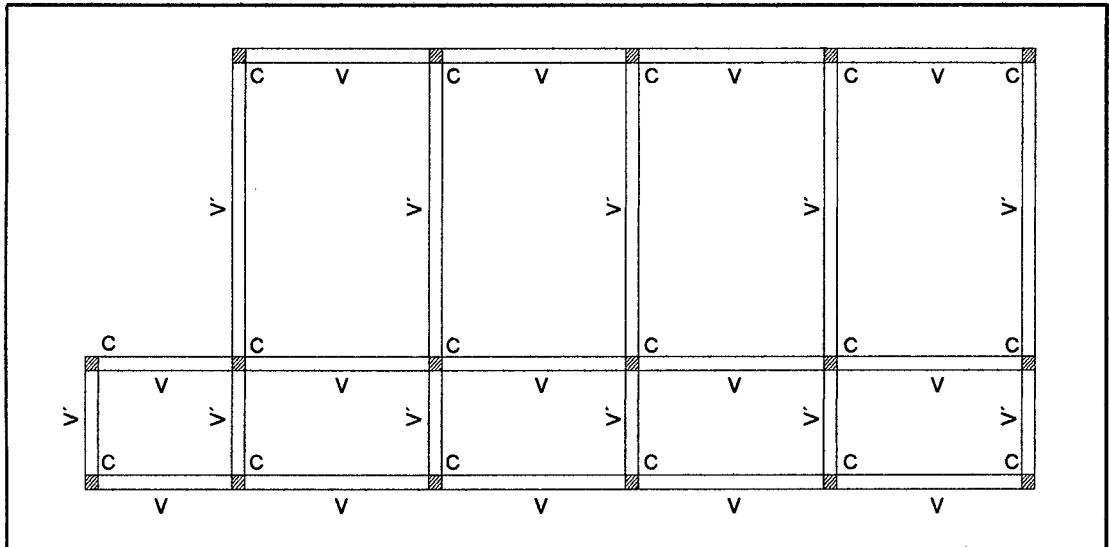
Configuración en planta de los elementos resistentes del pabellón 1.
